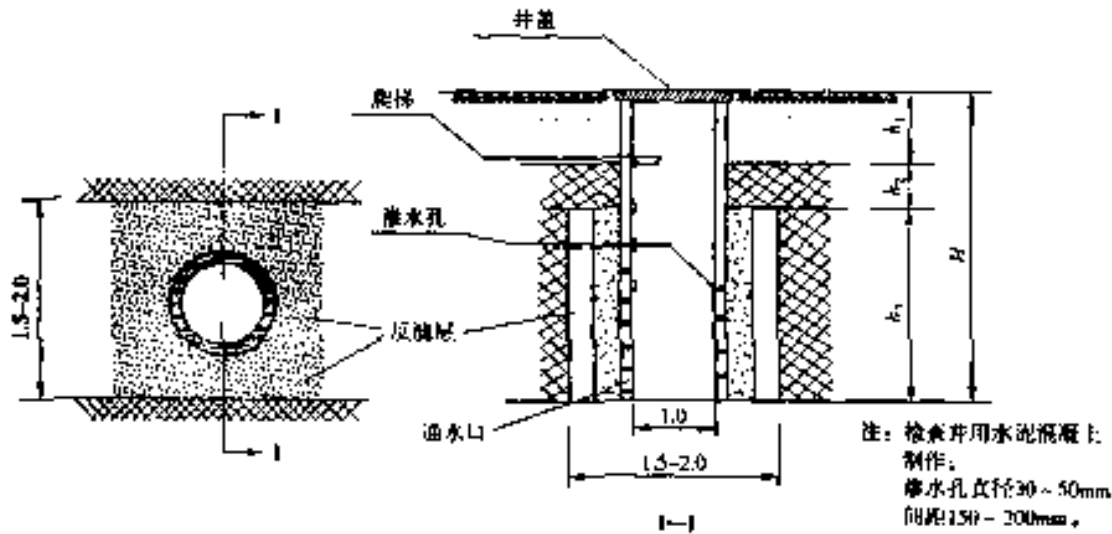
渗沟检查井(尺寸单位:m)
